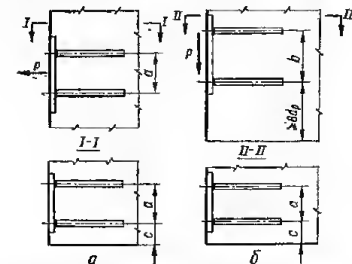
Расстояния между осями расчетных анкеров и от оси крайнего анкера до грани элемента:
